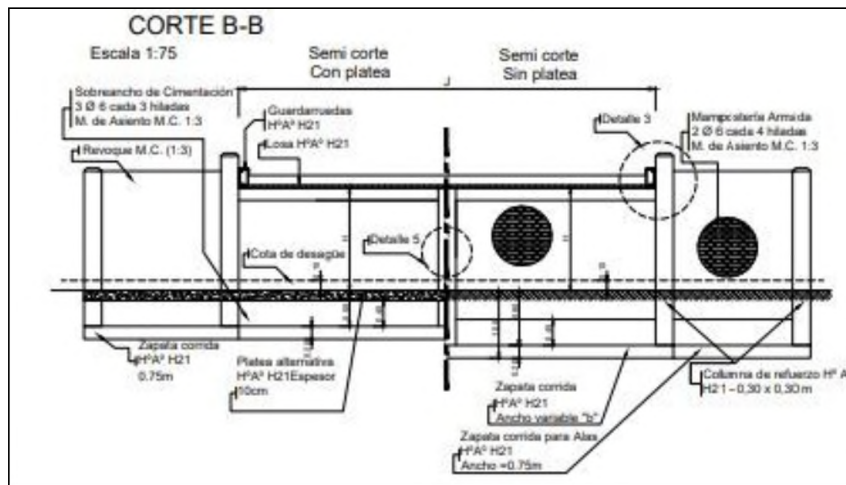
Corte Longitudinal de alcantarilla tipo del APA
